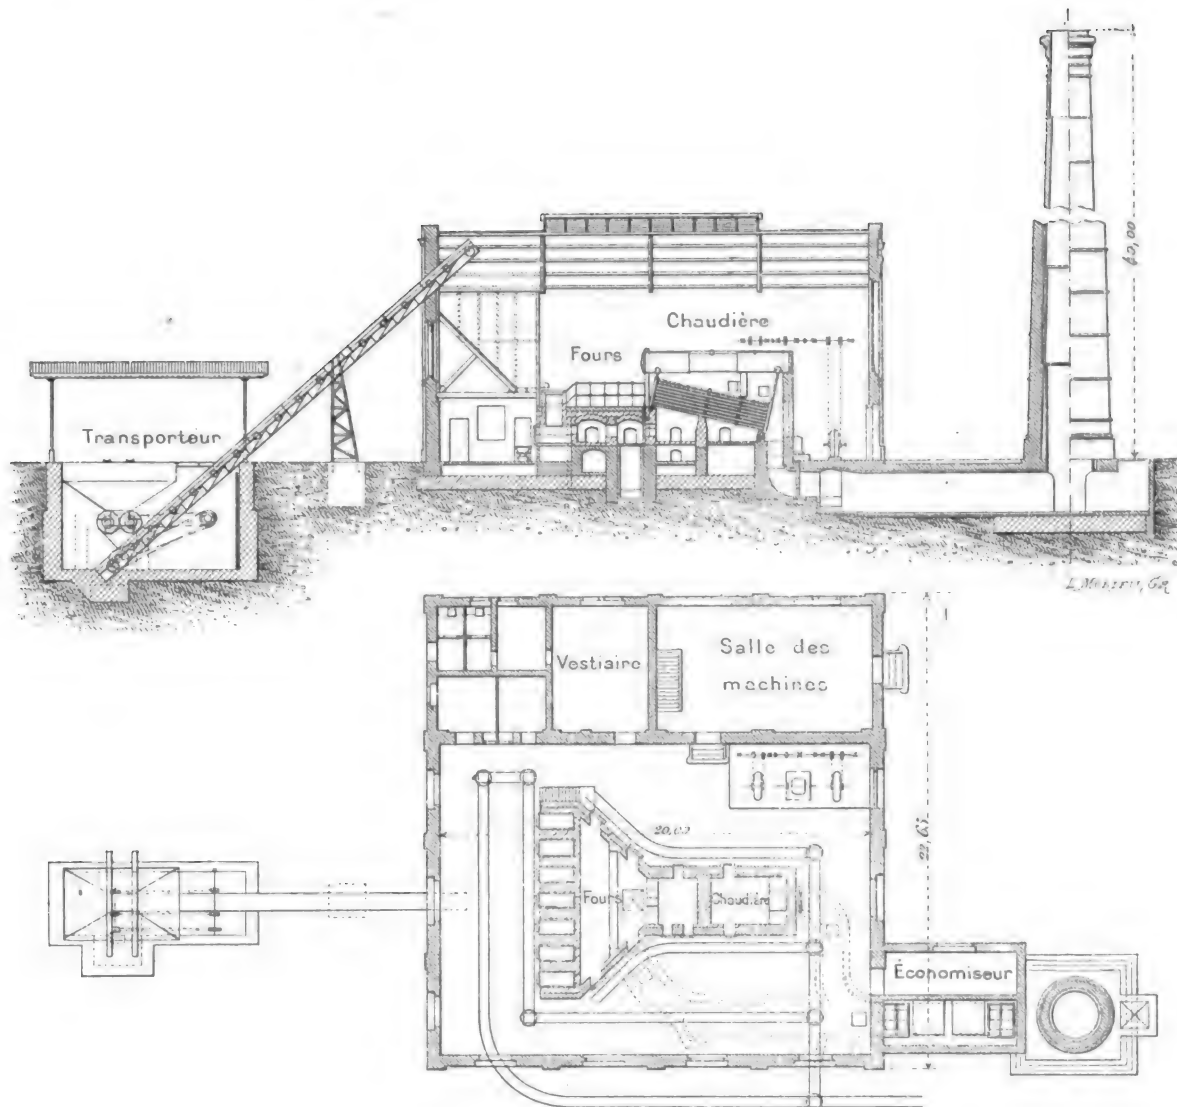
Élévation, coupe et plan de l'usine d'incinération des ordures de Brunn.
